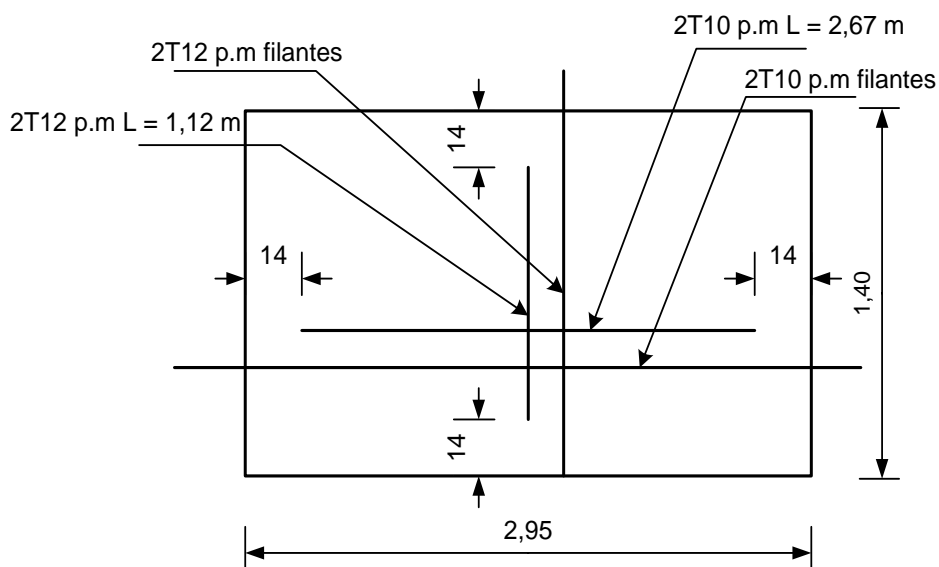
Dessin de ferrailage d'une dalle sur trois appuis (balcon type 03)
